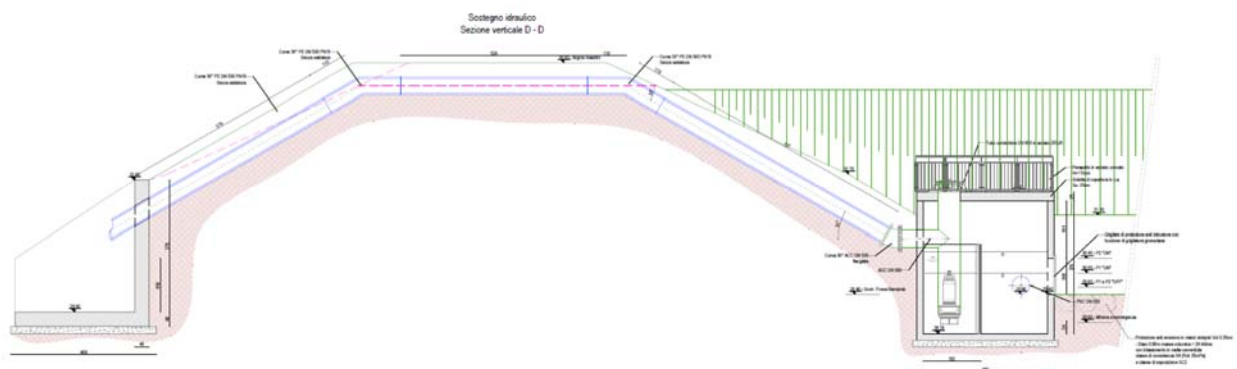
Sezione verticale longitudinale impianto di sollevamento.
